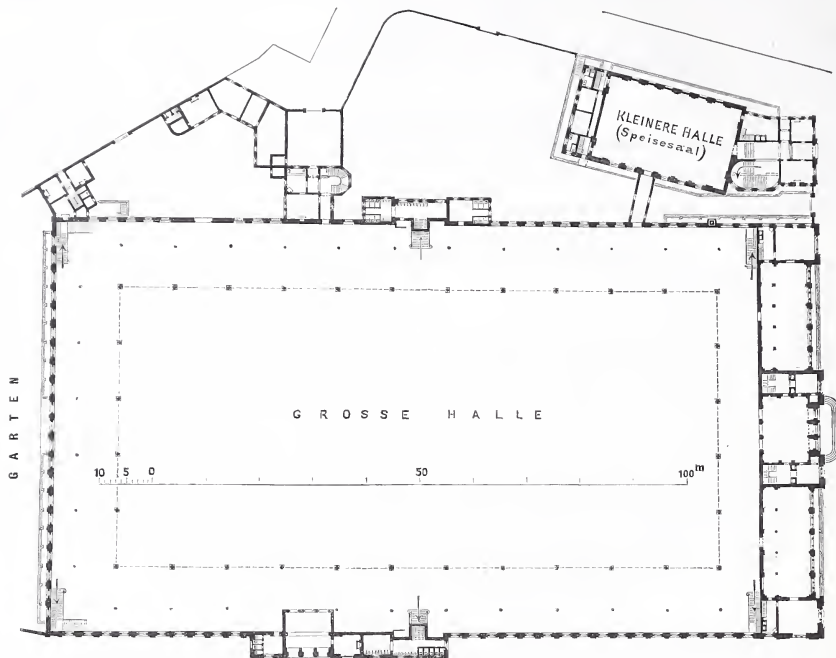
Grundriss der Kensington-Halle in London.
